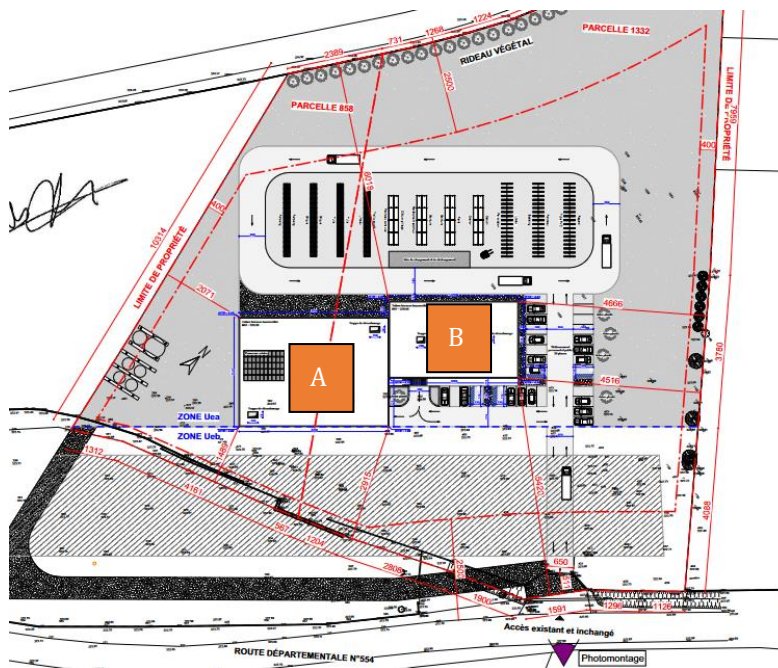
Plan du futur projet (Entrepôts = A ; Bureaux/Magasin = B)
